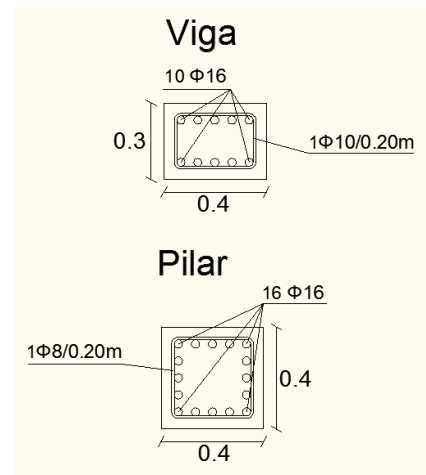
b Detalle de las armaduras de la viga y los pilares
